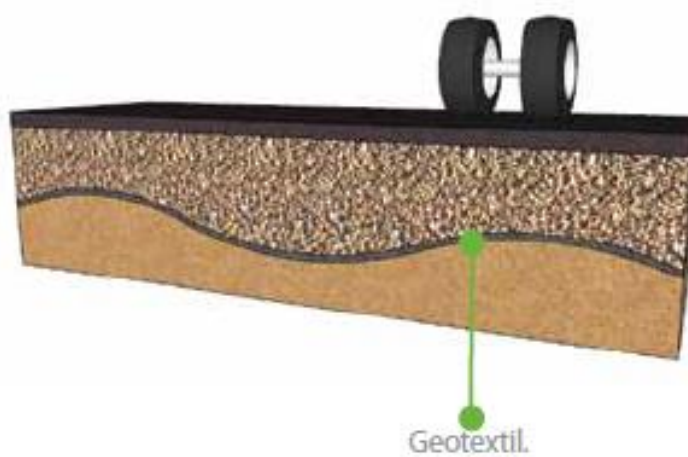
Alternativa 3: Comportamiento del geotextil.
